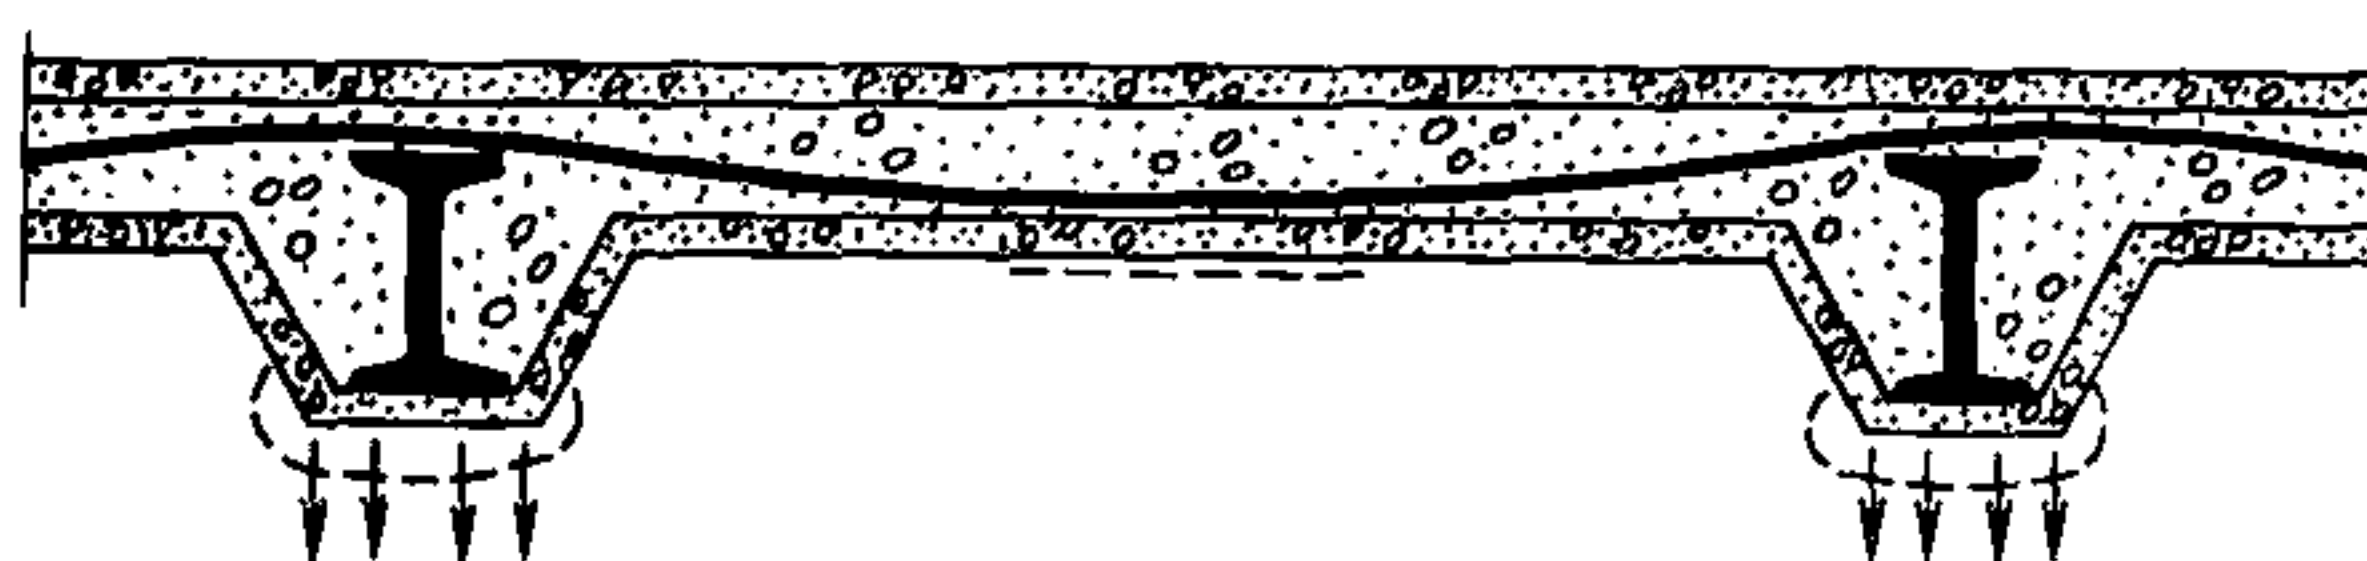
Трещины в железобетонной потолочной плите, коррозия нижних полок металлических балок и выпучивание бетона
